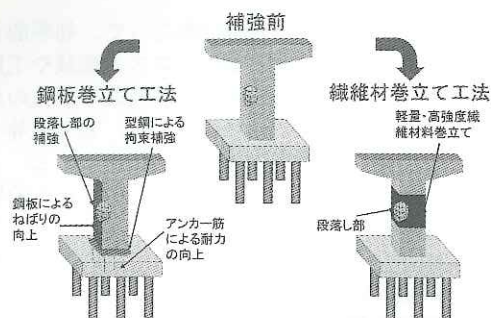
鉄筋コンクリート橋脚に対する一般的な橋脚の耐震補強工法
